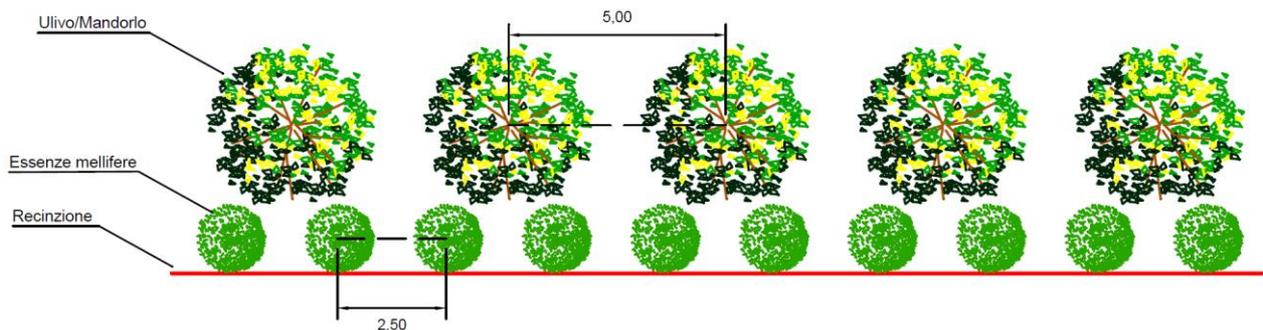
Fascia di mitigazione - schema in pianta del sesto di impianto
